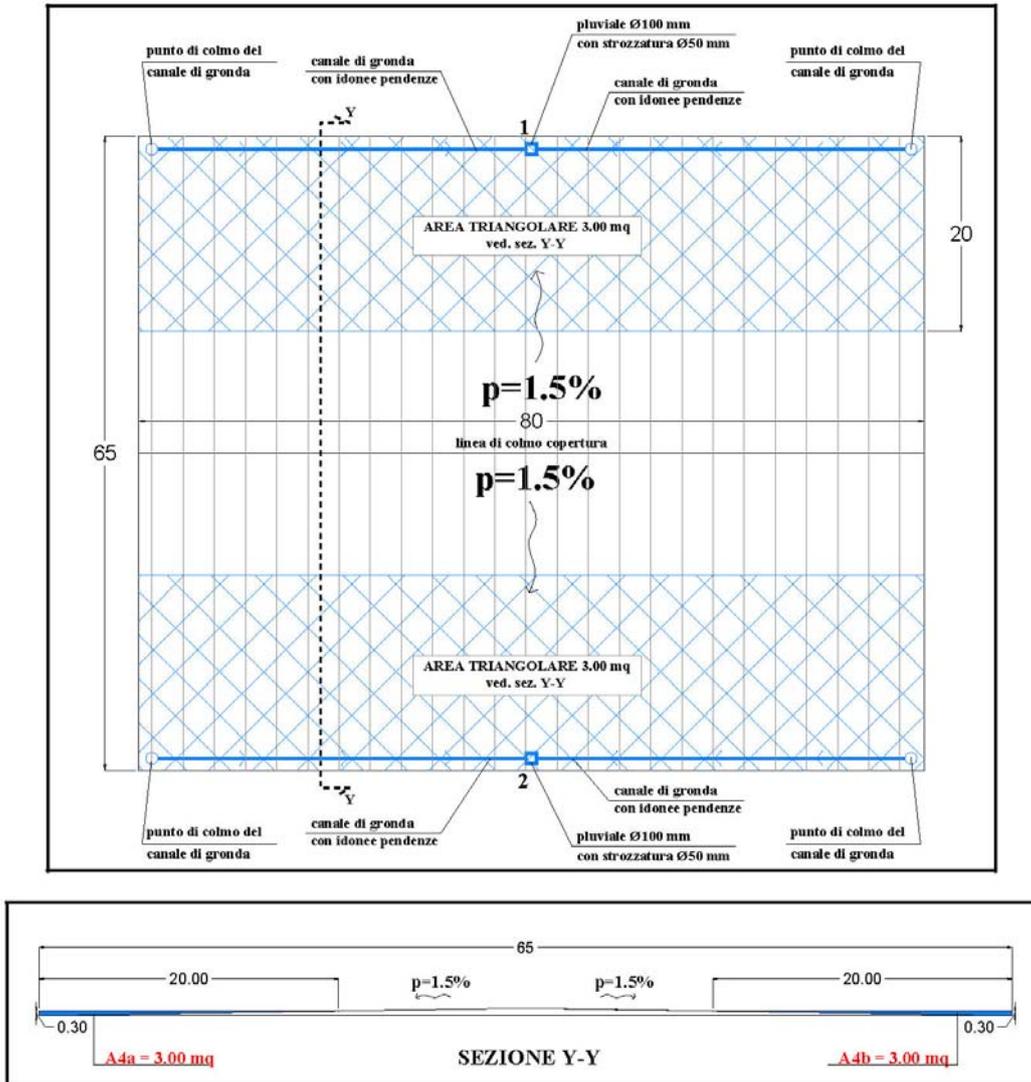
Pianta e sezione trasversale Y-Y della copertura edificio 4
